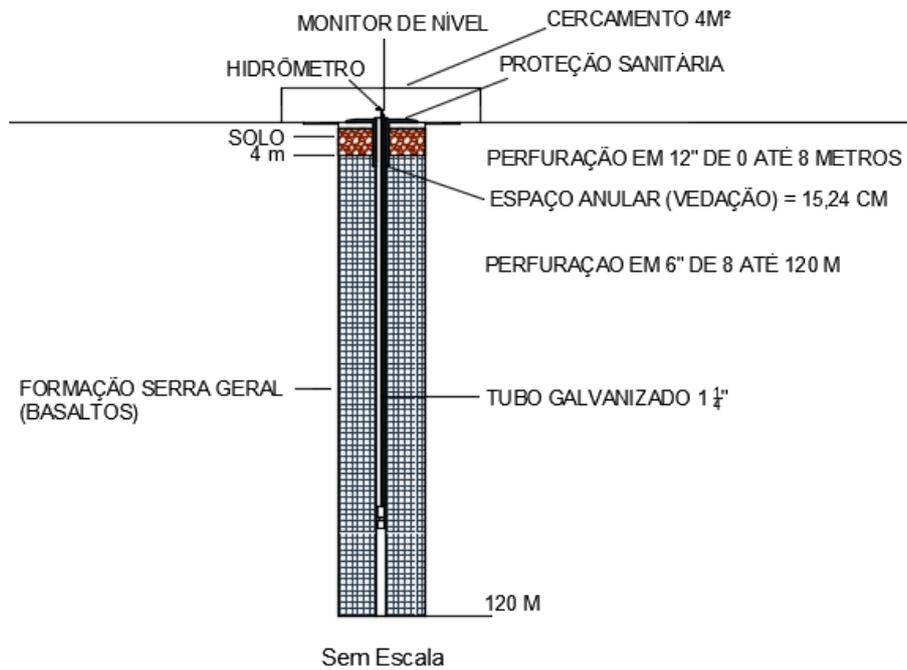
Perfil Construtivo do Poço. Fonte: Autor (2023).
